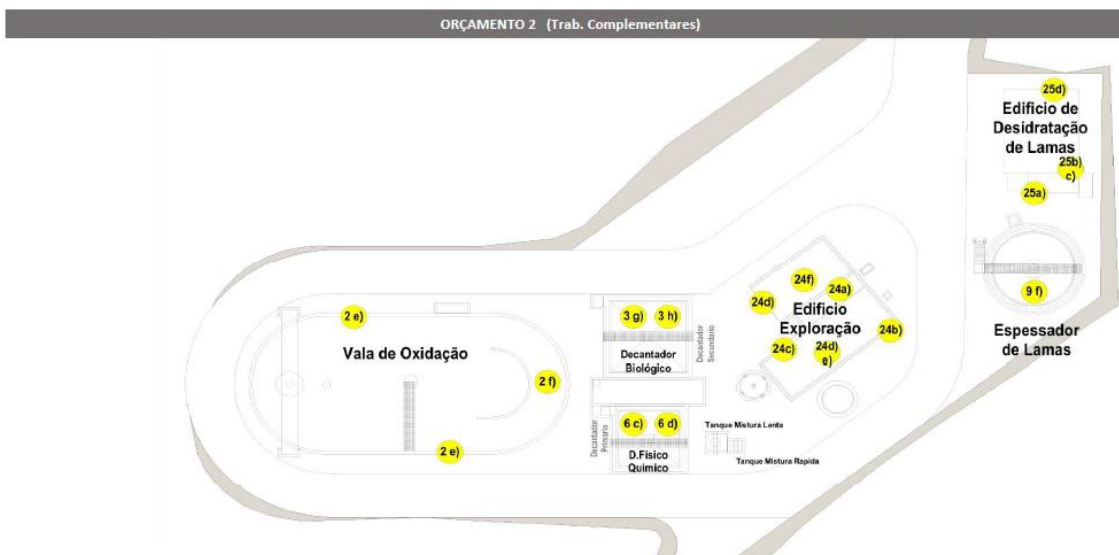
Planta da ETAL, 2. (Fonte: ERSUC, S.A, 2022)
